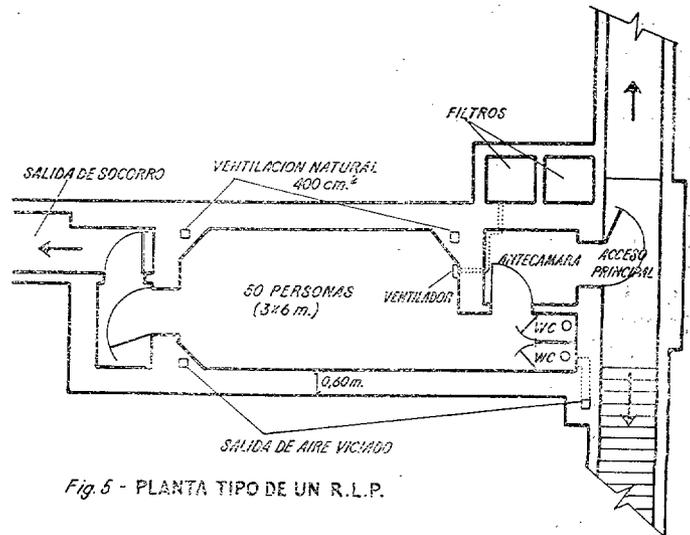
PLANTA TIPO DE UN R.I.P.
